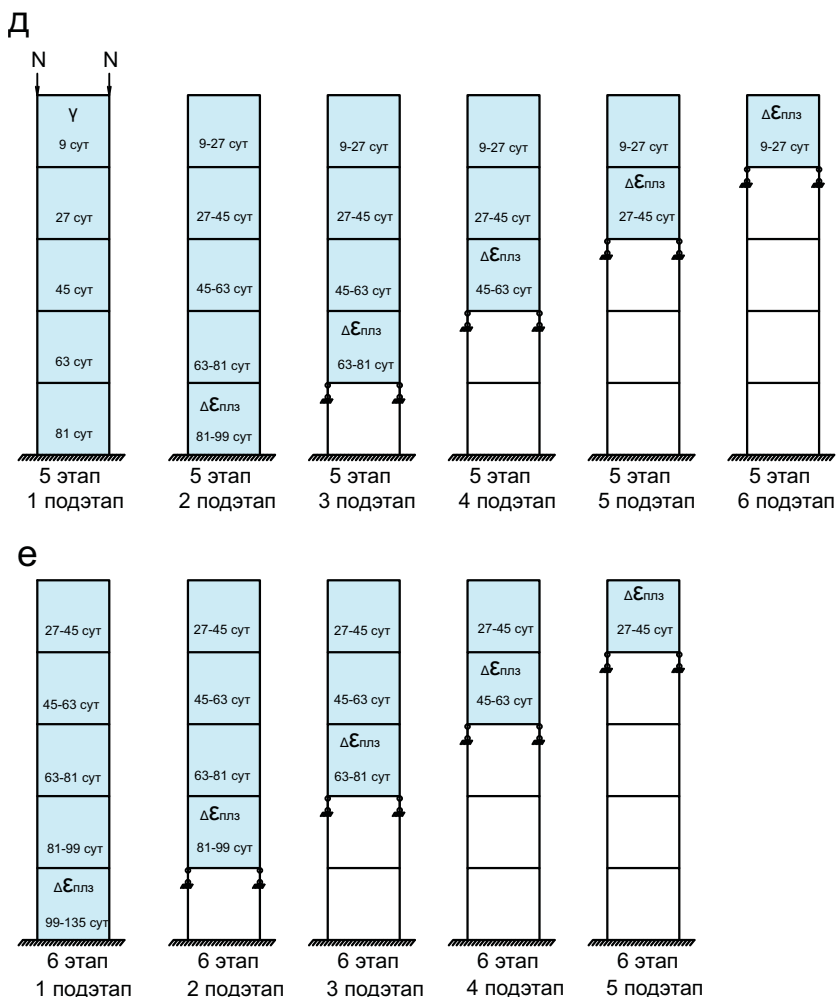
(продолжение). Этапы расчета пятиэтажного фрагмента стены из многослойной кладки с вертикальными диафрагмами: д – 5-й этап; е – 6-й этап
